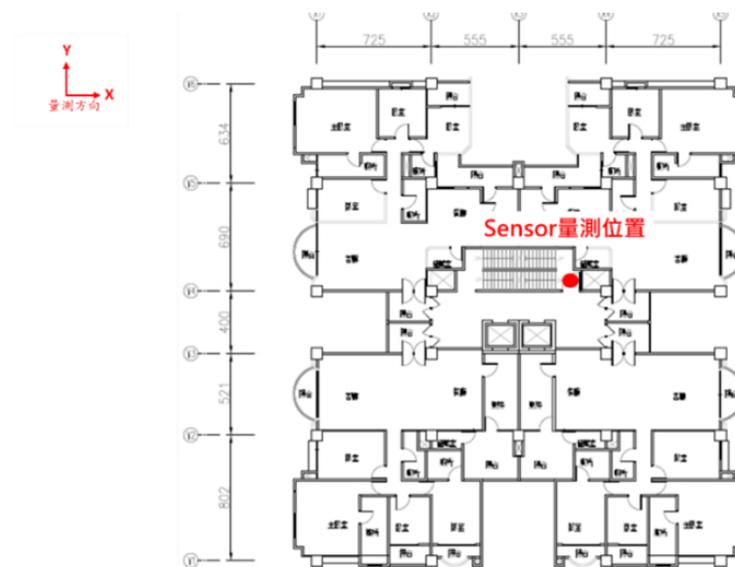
儀器佈置 6 樓、9 樓樓層平面圖
